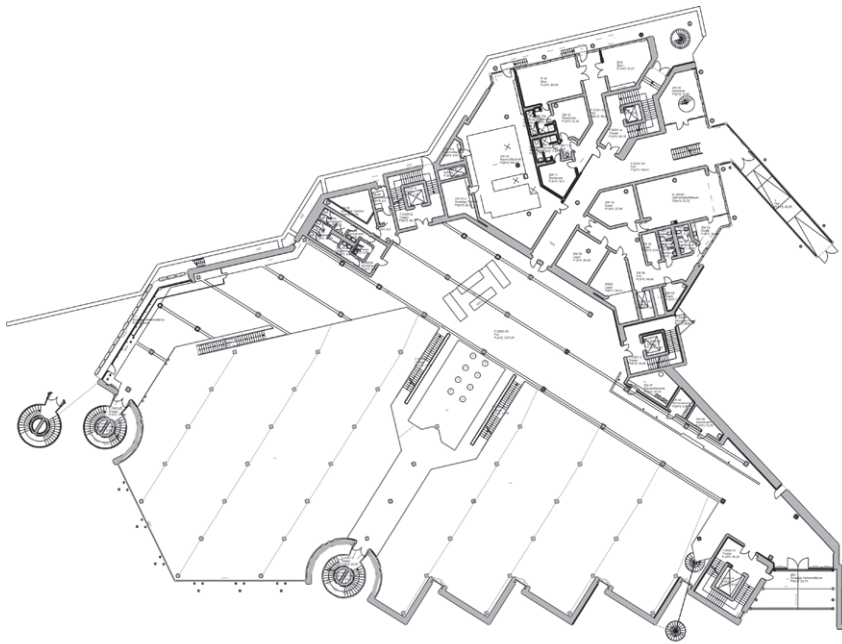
Grundriss Haupthaus 1. Obergeschoss auf der Ebene + 39,72 m üNNH
